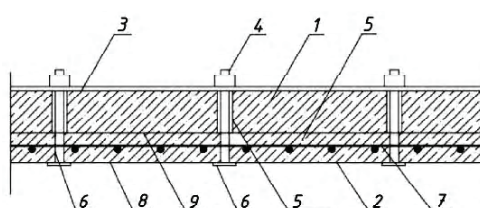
Устройство железобетонного нарастивания снизу плиты при недостаточном сцеплении нового бетона со старым: 1 – усиваемая железобетонная плита; 2 – железобетонное нарастивание; 3 – стальная полоса, прикрепленная к плите анкерными болтами; 4 – анкерные болты, установленные в просверленные в плите отверстия; 5 – отверстия, просверленные в плите; 6 – шайбы; 7 – арматурная сетка, приваренная к стальным полосам; 8 – бетон нарастивания, наносимый методом торкретирования; 9 – поверхность усиваемой плиты, подготовленная к бетонированию).
